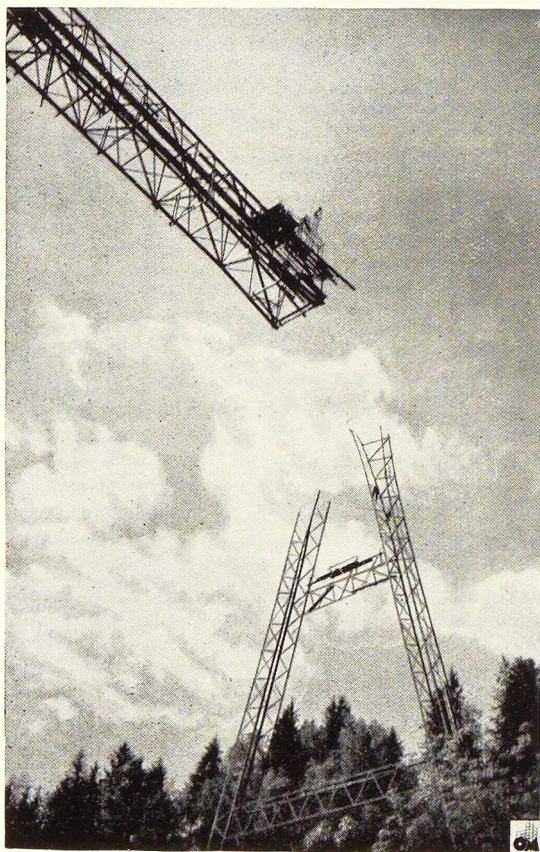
Montage en porte-à-faux des poutres du viaduc.
